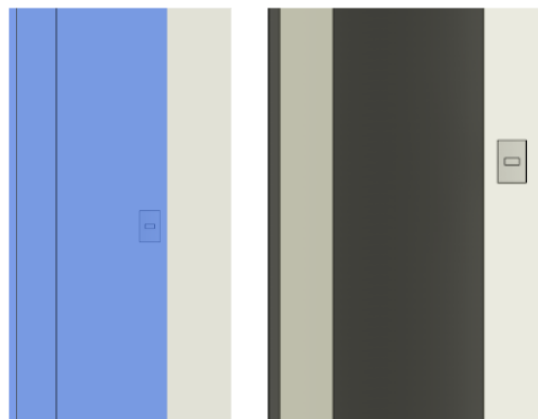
Interruptor conflitando com o pilar (Pavimento 2)
